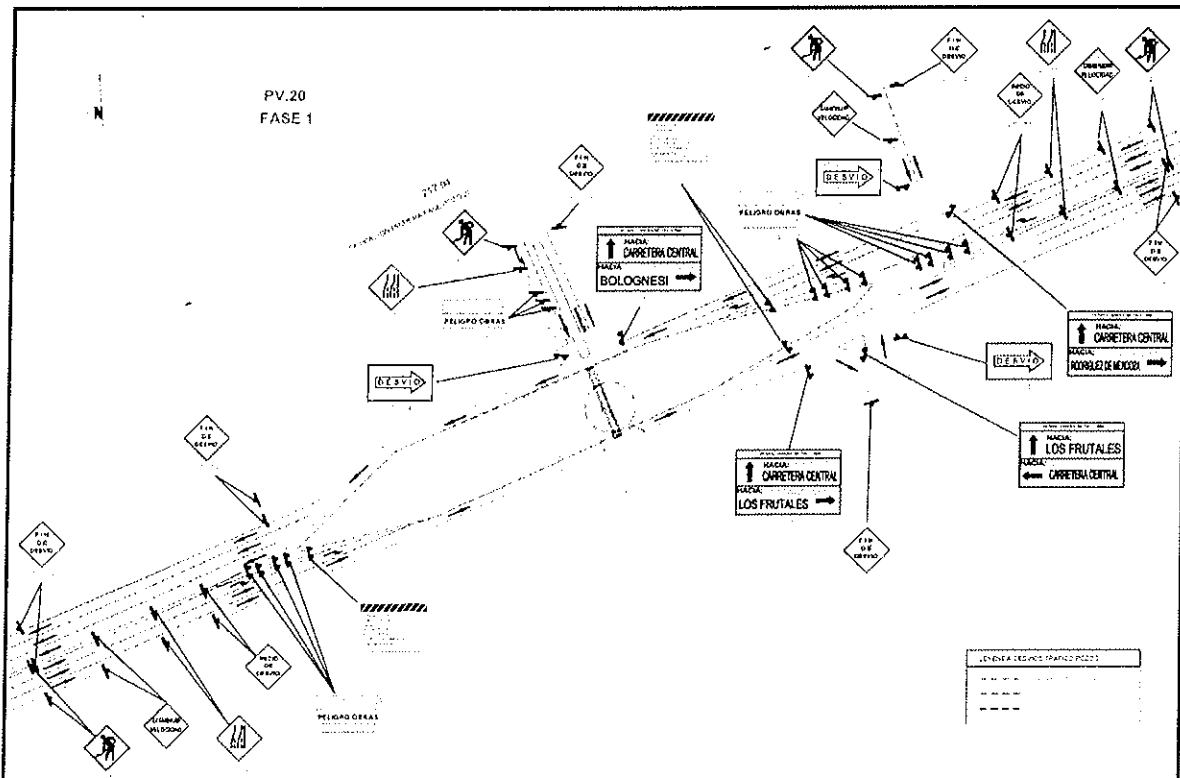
Plano tipo de señalización del desvío de tránsito en el ámbito de la construcción de un pozo
